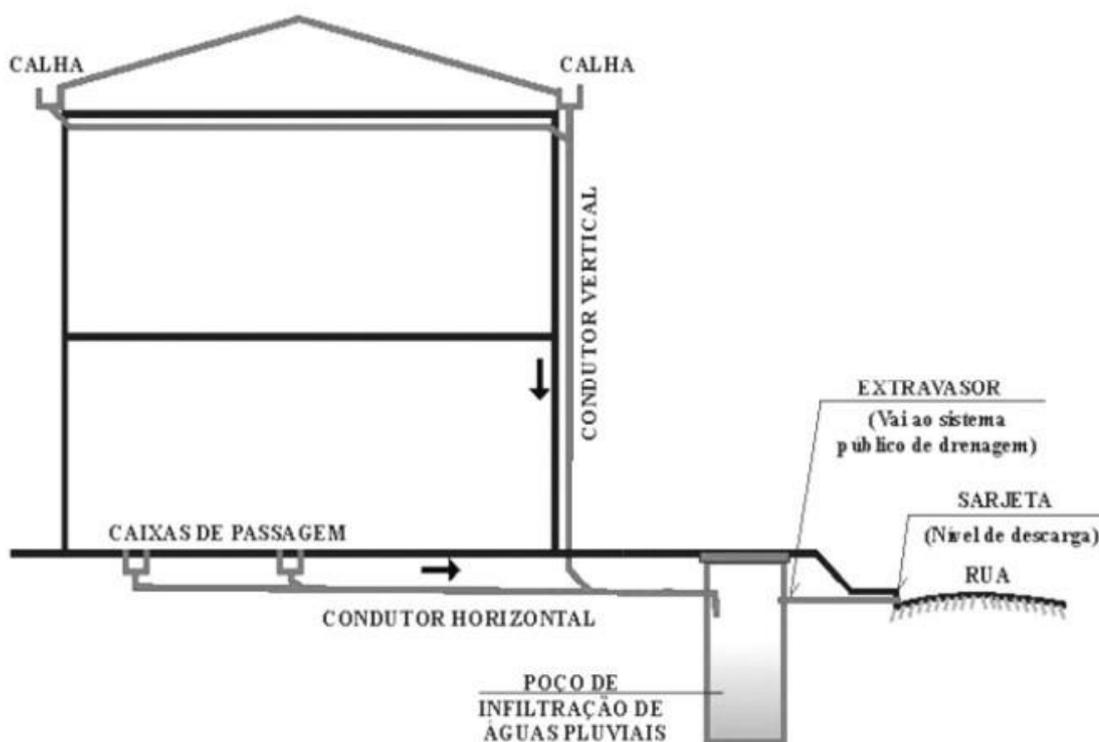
Exemplo de poço drenante instalado em uma edificação (Fonte: Reis, R. P. A; Oliveira 2008)
